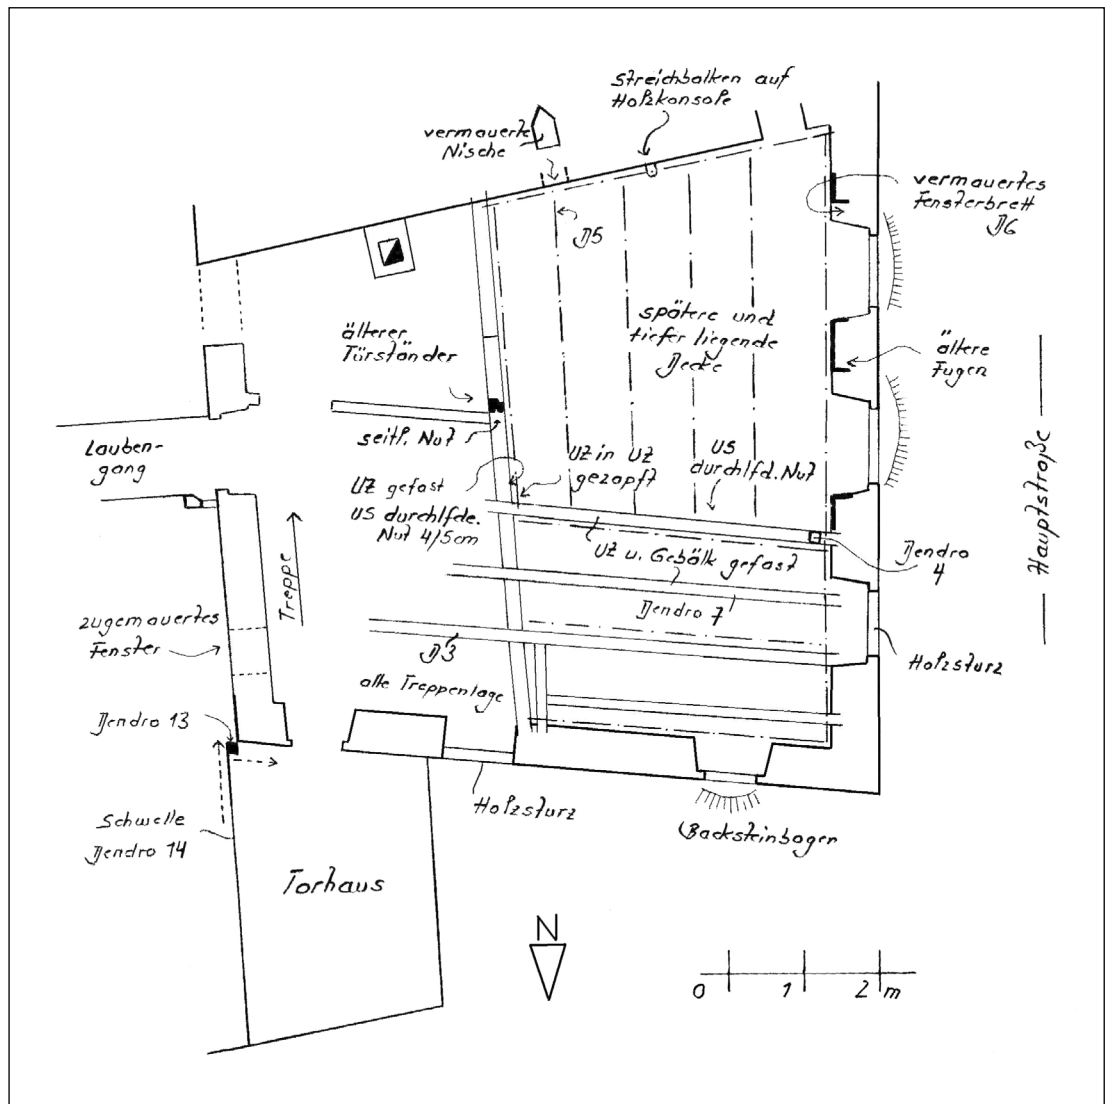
Hauptstraße 15, Grundriss 1. Obergeschoss.
